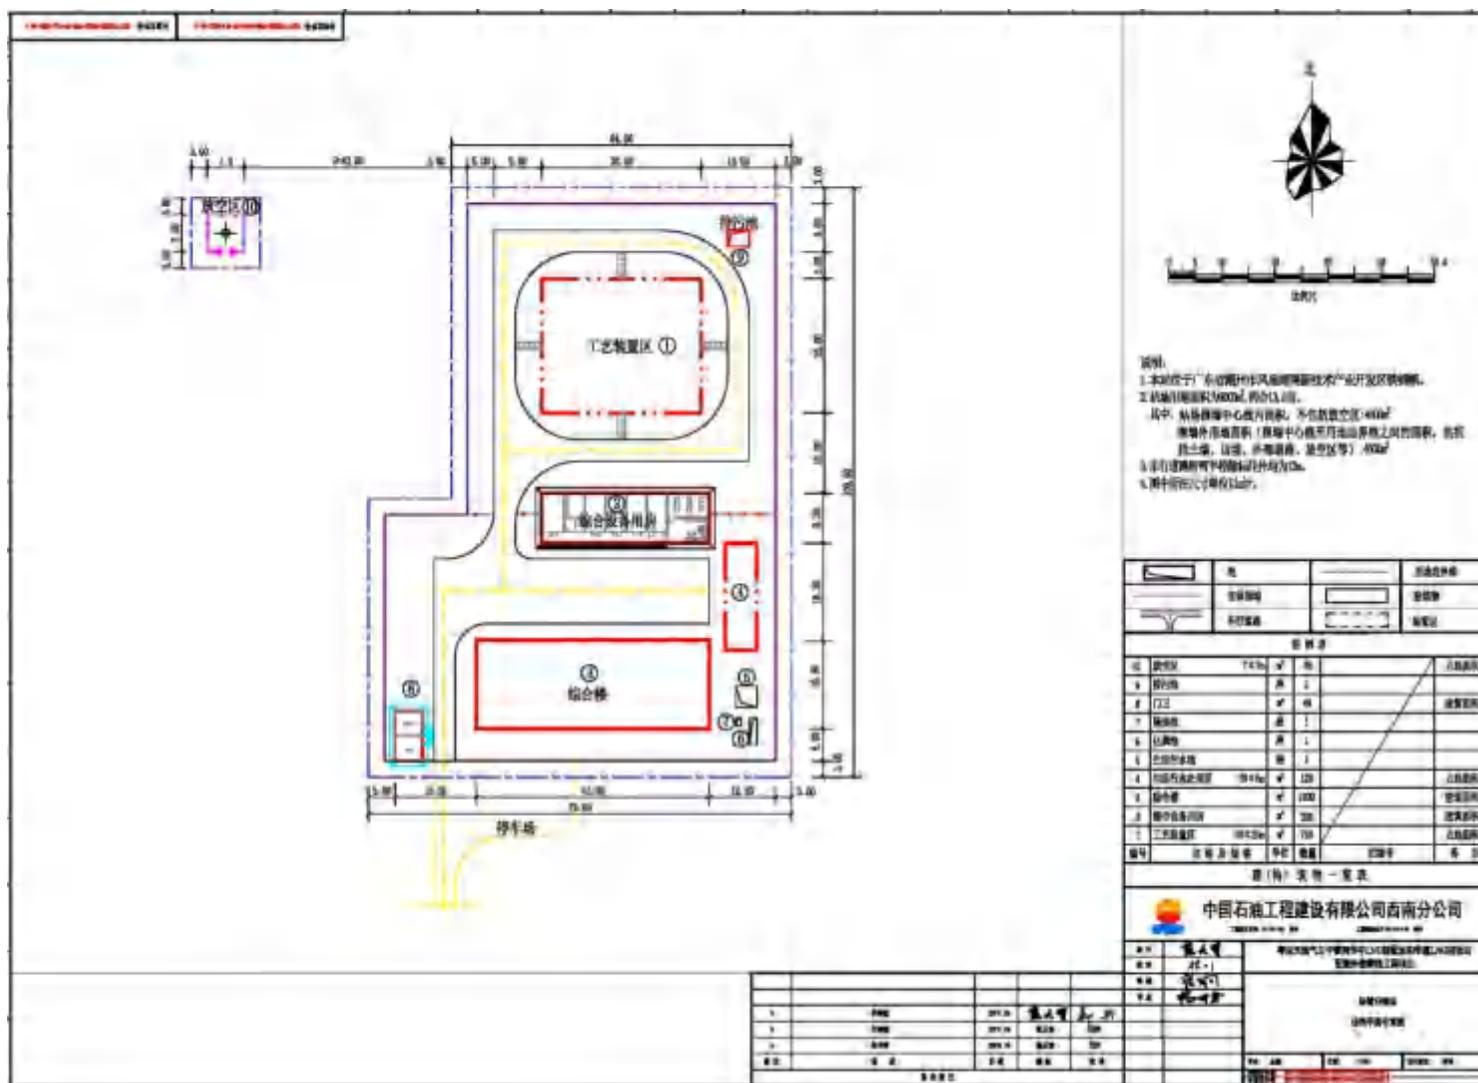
(1) 铁铺分输站平面布置图 (环评阶段)
